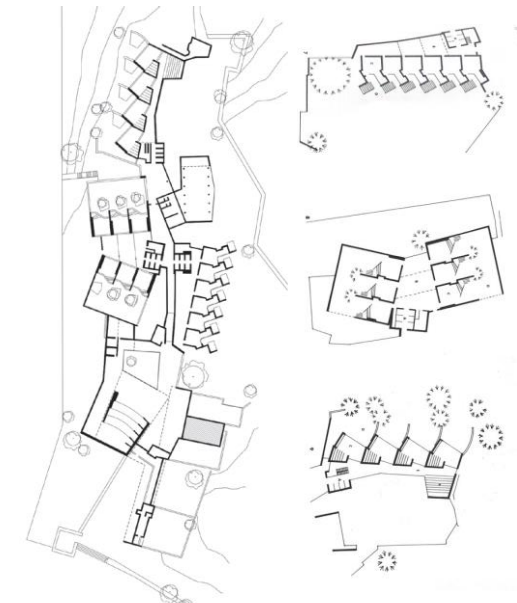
Planta general y partes de la planta baja, media y alta del proyecto de la escuela en Darmstadt 1951, Hans Scharoun.
